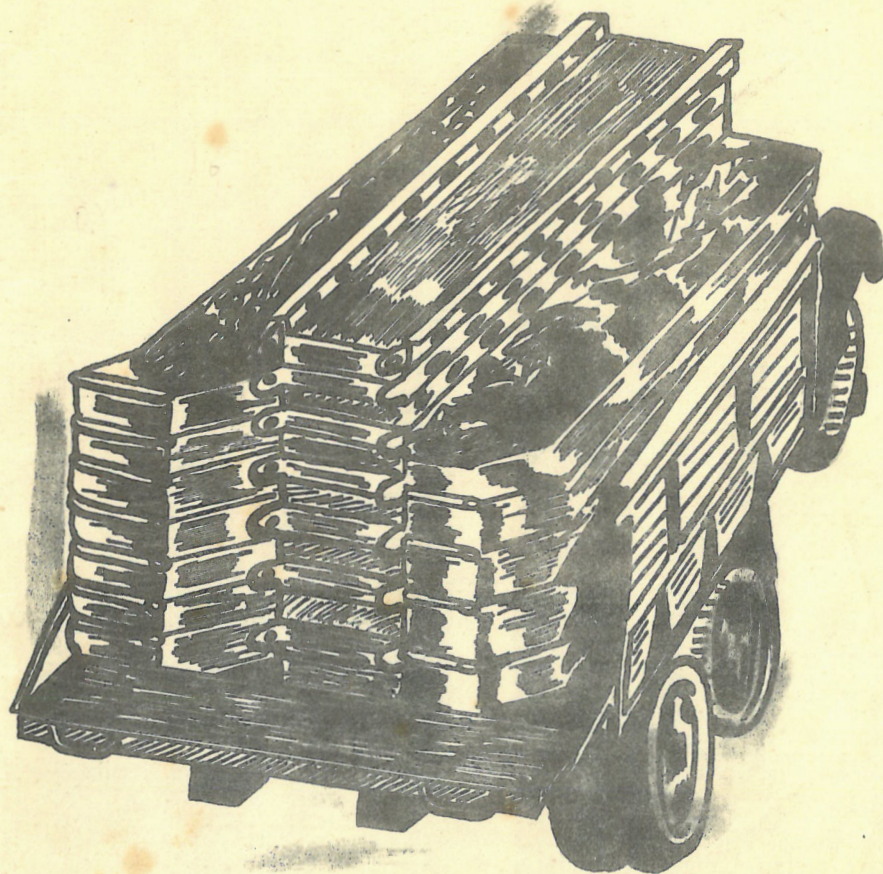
CAMION DE 2½ TONELADAS LLEVANDO LA TERCERA PARTE DE LA PASARELA
